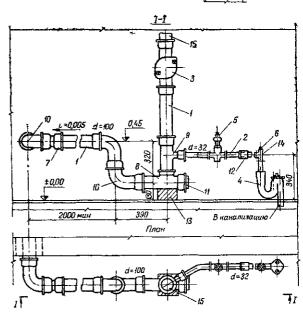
3 Выпуск водостоков на отмостку или поверхность грунта при расчетной температуре наружного воздуха от —5 до —25° С с установкой чугунных гидравлических затворов
